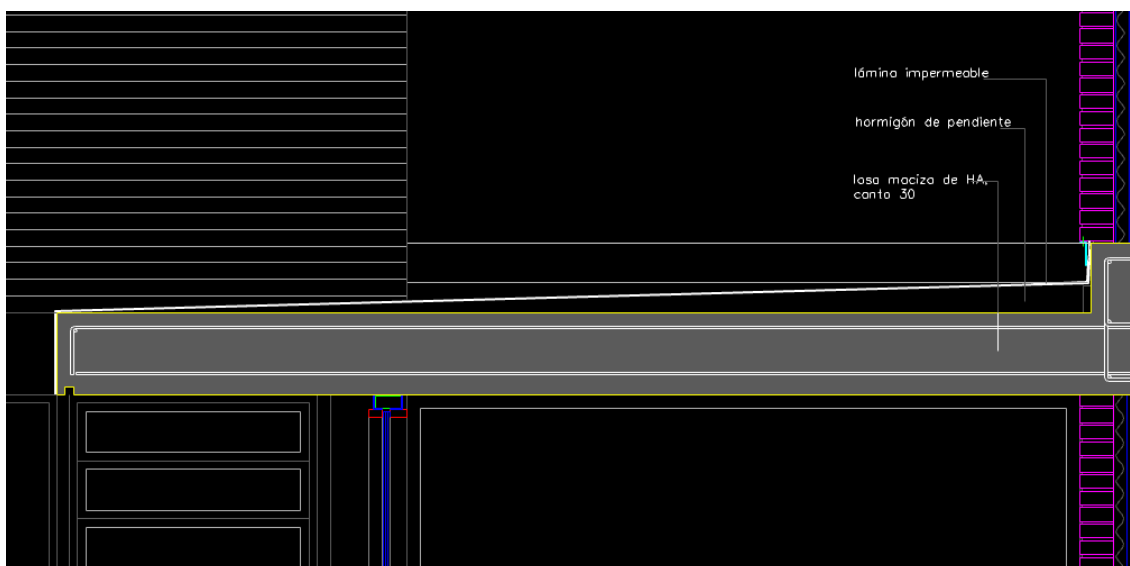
Cubierta de losa de hormigón en planta baja. Obtenido del proyecto de ejecución.
